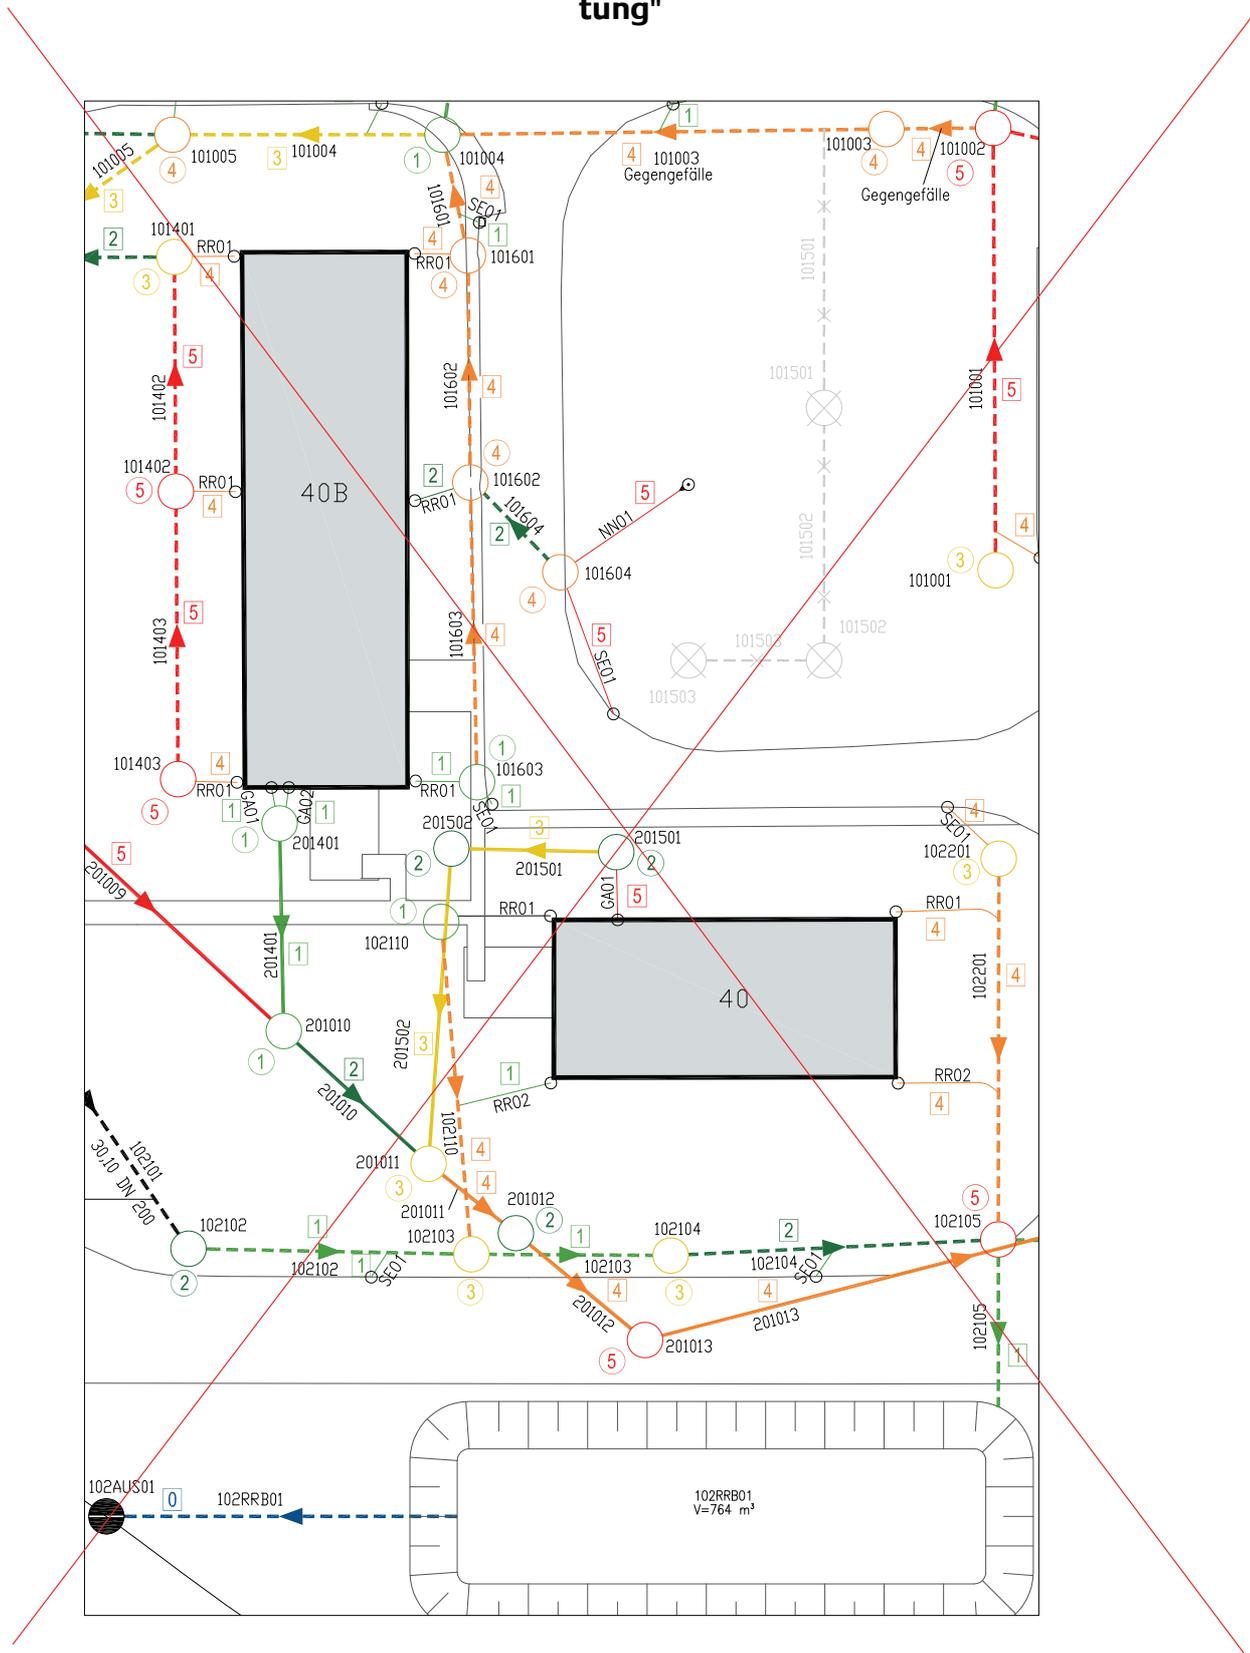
Beispielplan: Lageplan "Bautechnische Zustandsbewertung"
